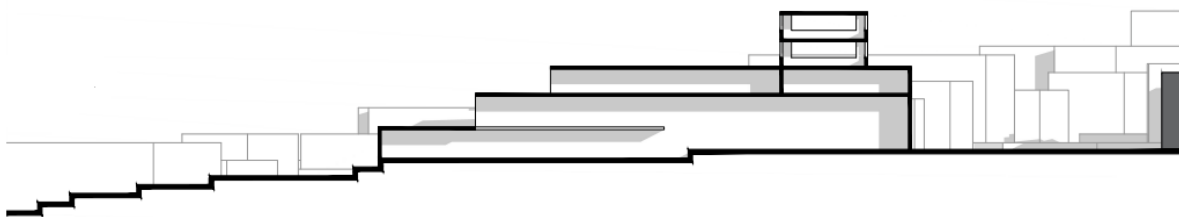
Sección B-B' - Anteproyecto 01. Elaboración propia.
